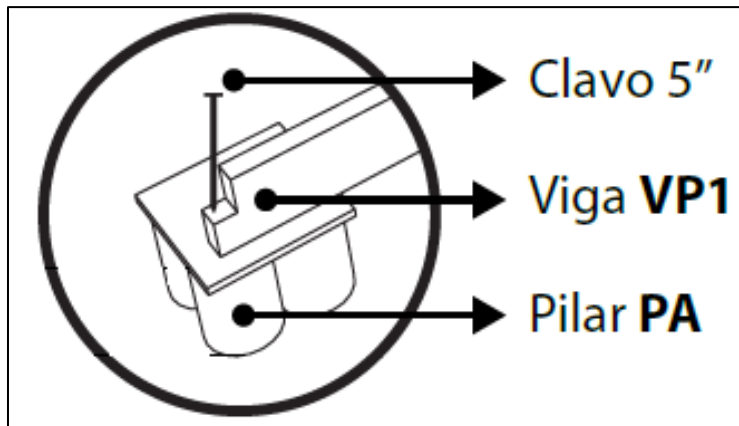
Figura XII: Detalle de viga y pilares de cimentación – modelo 2
